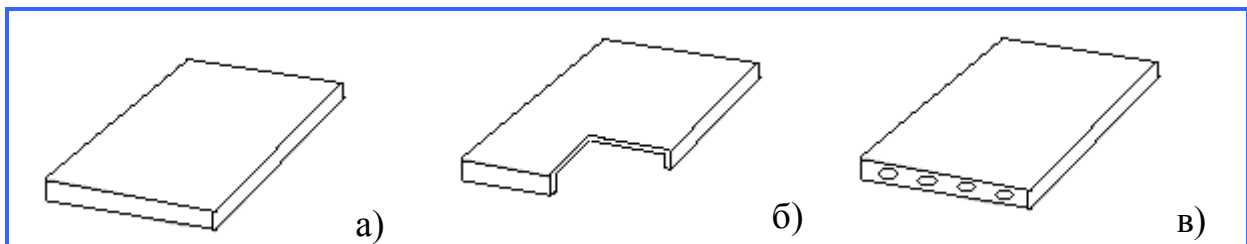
Збірні залізобетонні панелі перекриття: а) суцільна; б) ребриста; в) кругло пустотна.
